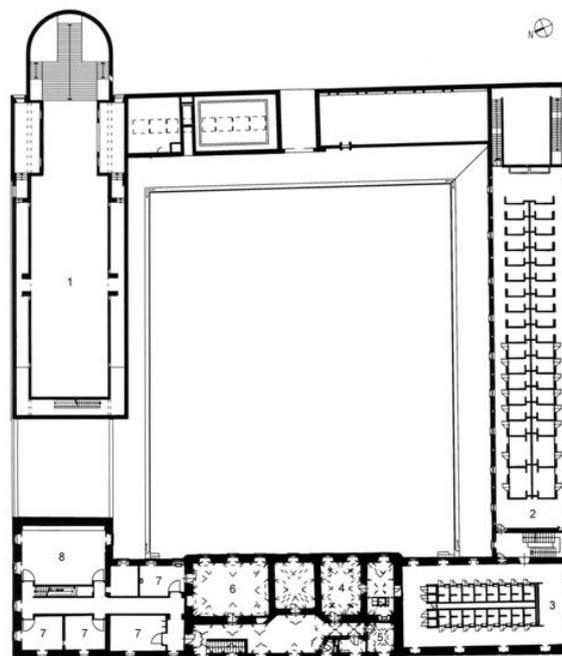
Planta 2º pavimento. Fonte: Atelier Soukup.
